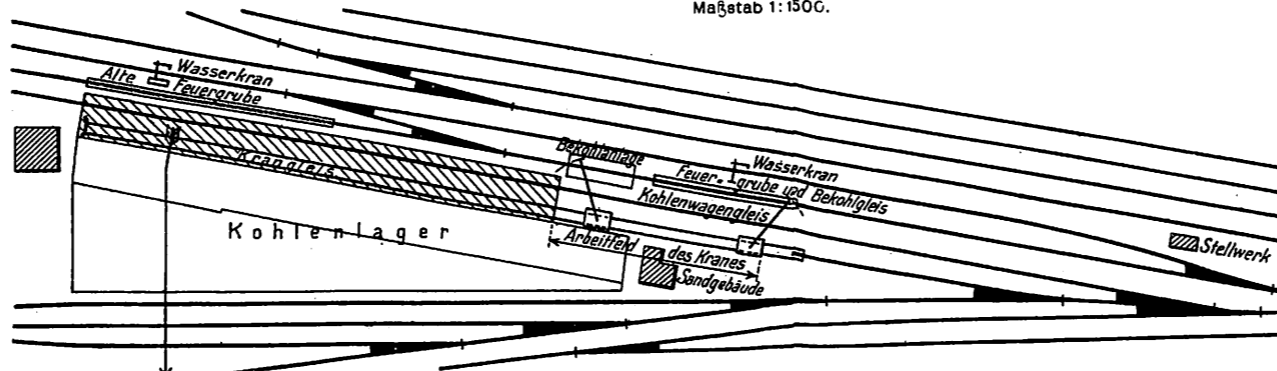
Lageplan der Anlage zum Bekohlen auf Bahnhof Frintrop.
